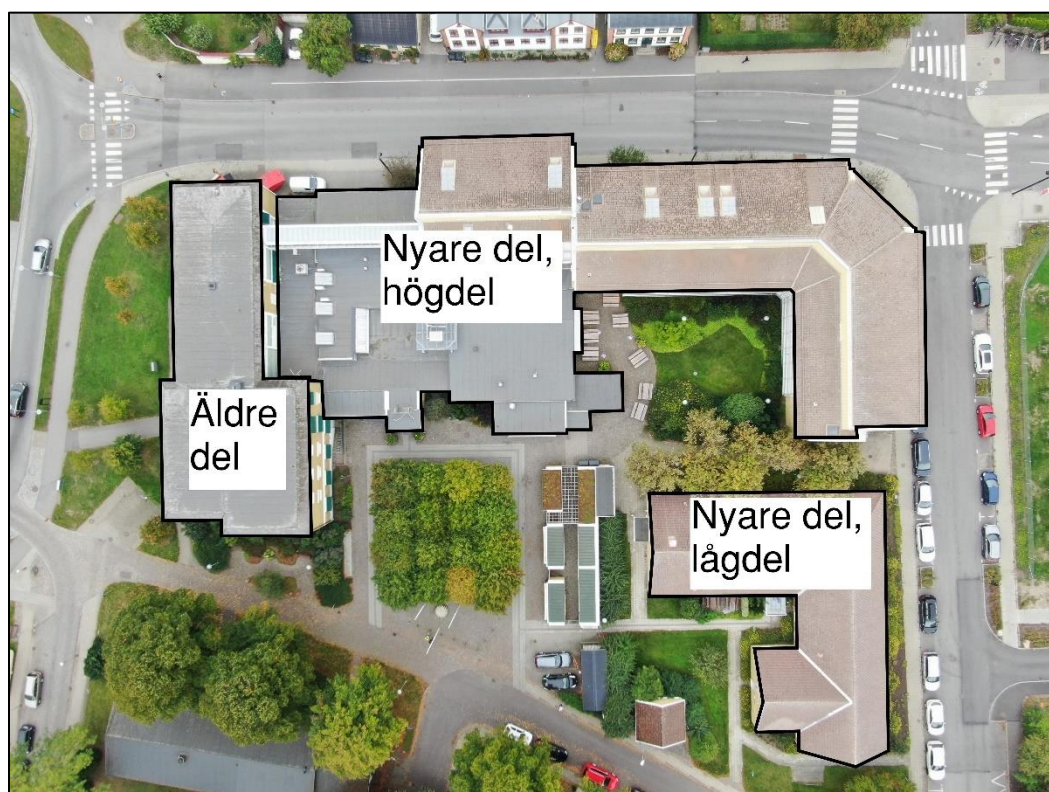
Här visas hur de olika delarna av byggnaderna indelas och benämns i rapporten.
